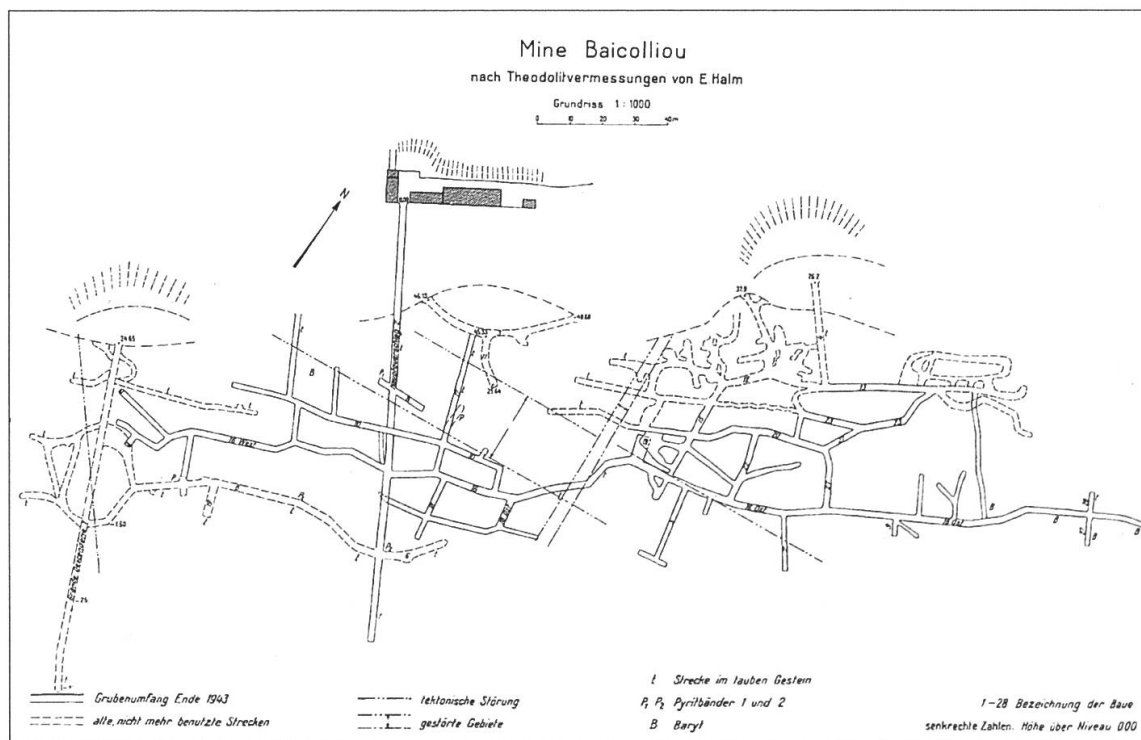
Mine de Baicolliou: plan de situation (HALM, 1942)
